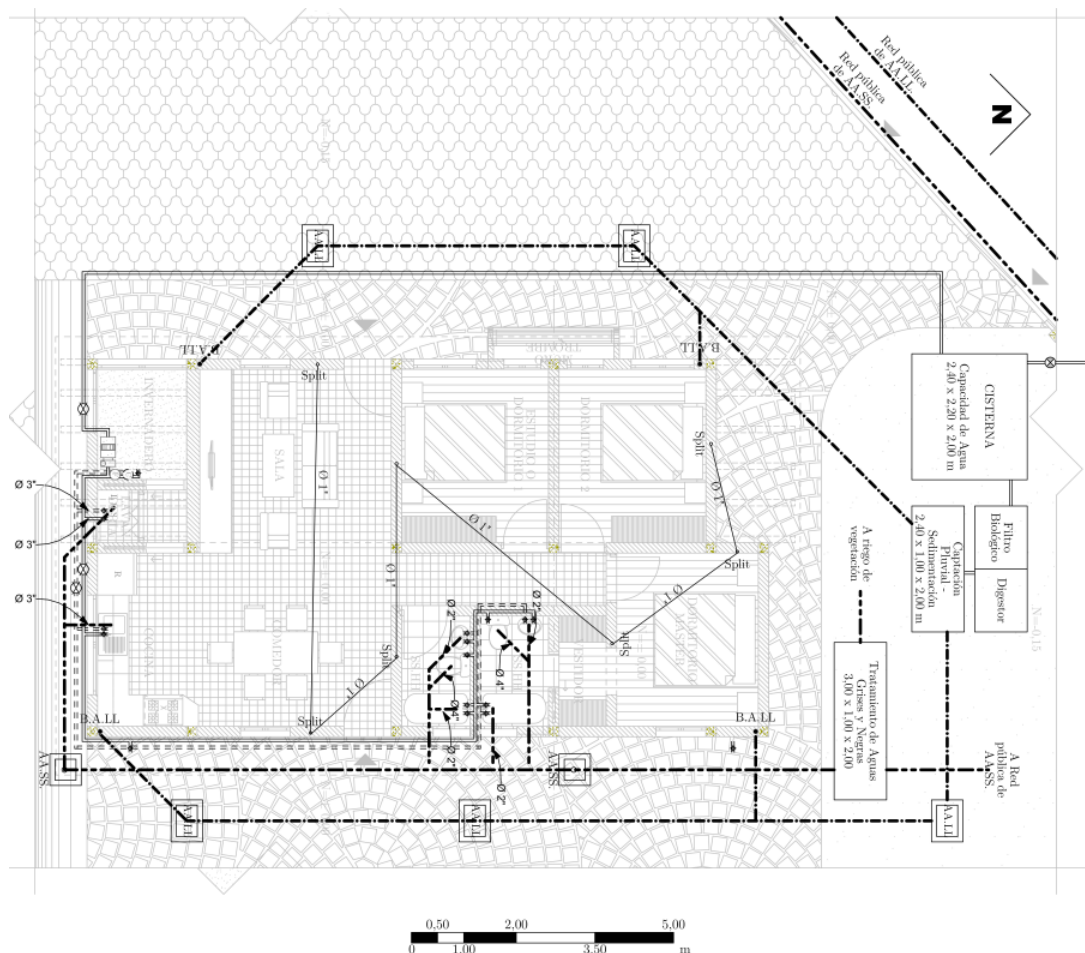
Instalaciones Sanitarias Planta Baja.
